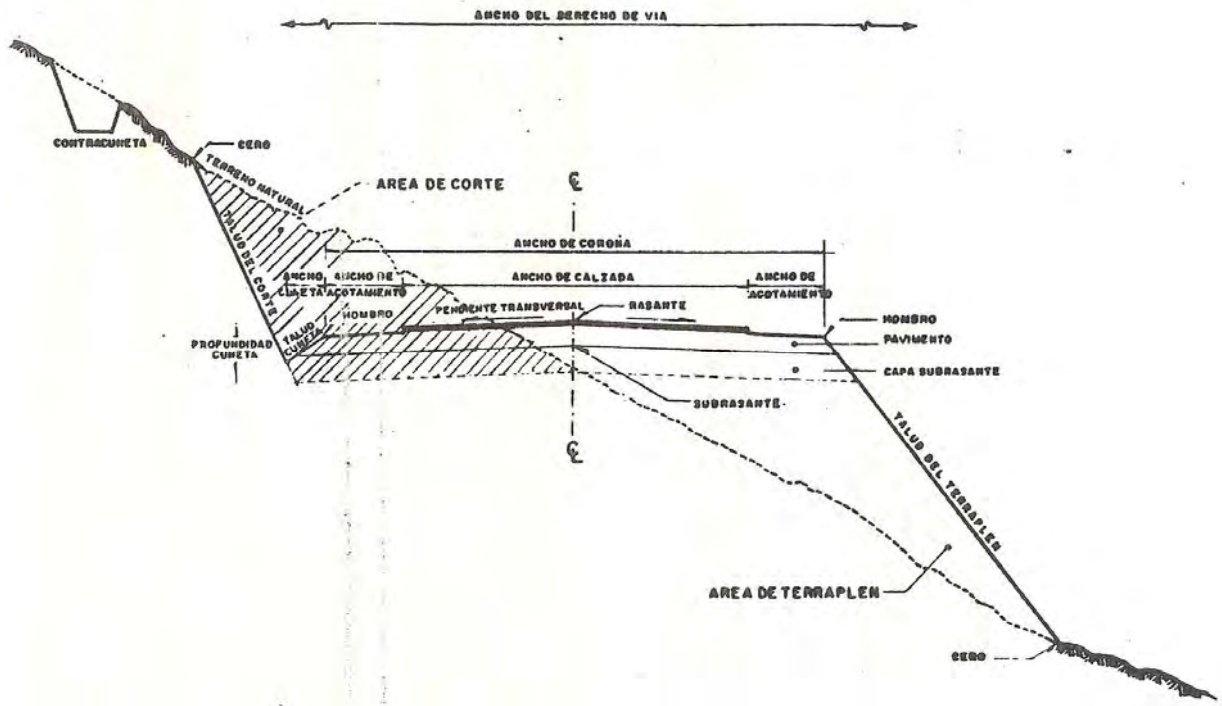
Sección transversal típica en una tangente del alineamiento horizontal.
